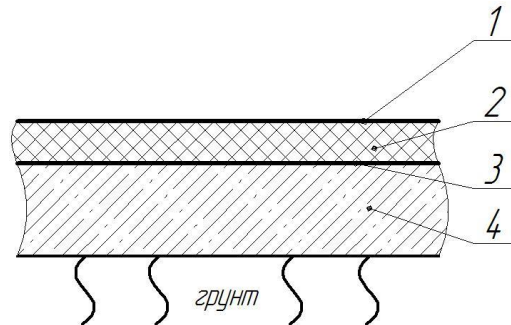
Переріз підлоги: 1, 3 – сталевий лист; 2 – утеплювач (пінопласт полістирольний ПСБ-С); 4 – залізобетонна плита; 5 – ґрунт
